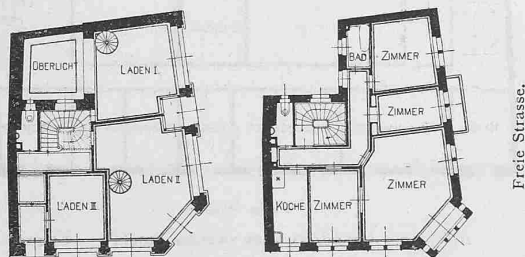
Grundrisse vom Erdgeschoss und vom III. Stock des Hauses
